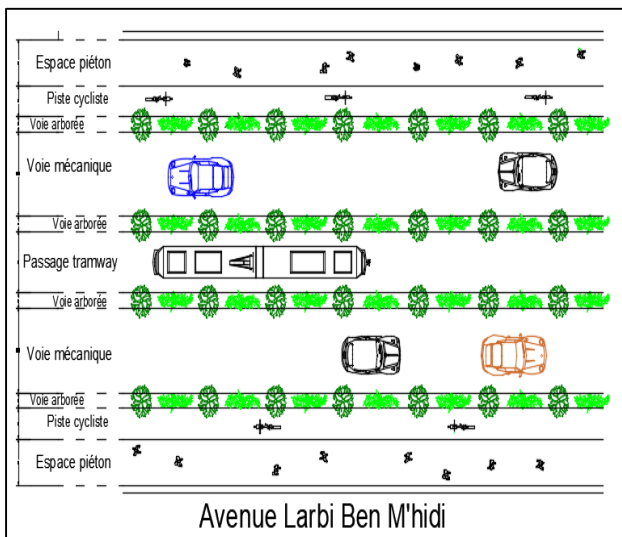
vue en plan de L'avenue Larbi Ben M'hidi après l'intervention, source : auteurs
